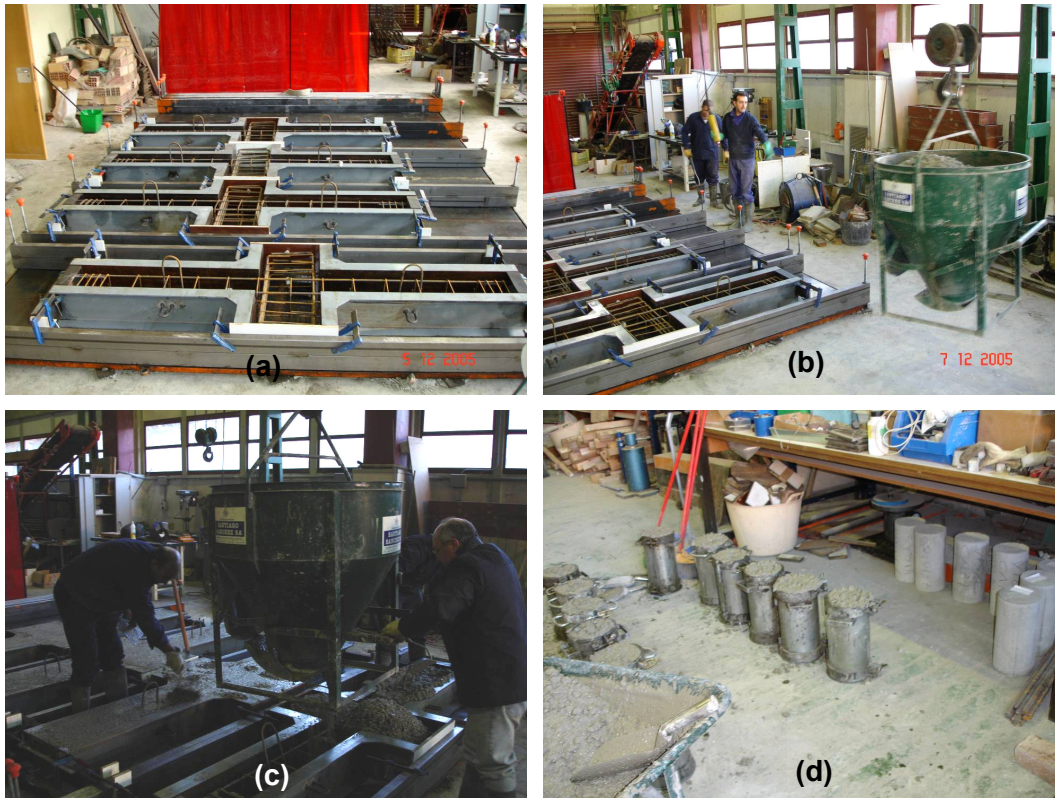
Hormigonado de las probetas. (a) Bancada de encofrado; (b) Transporte del hormigón con cubilote; (c) Hormigonado; (d) Probetas cilíndricas
